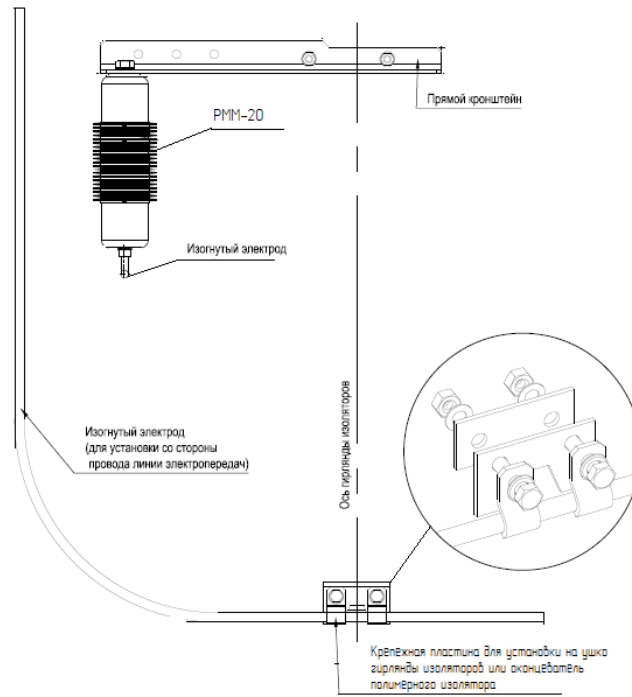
Комплект деталей для установки устройства RMM-20 на промежуточную опору с подвесными изоляторами.
